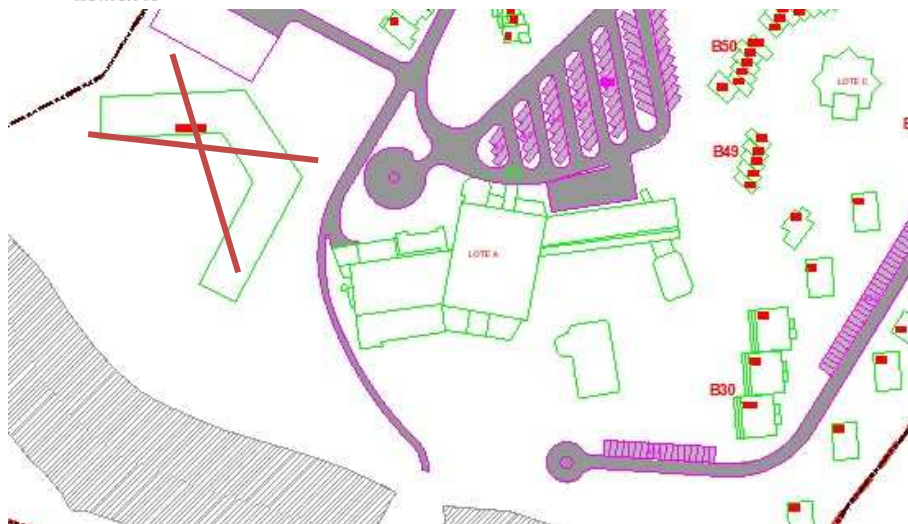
Extrato da Planta de Loteamento Vetorizado, com o lote B assinalado com um “X” de cor encarnada.
